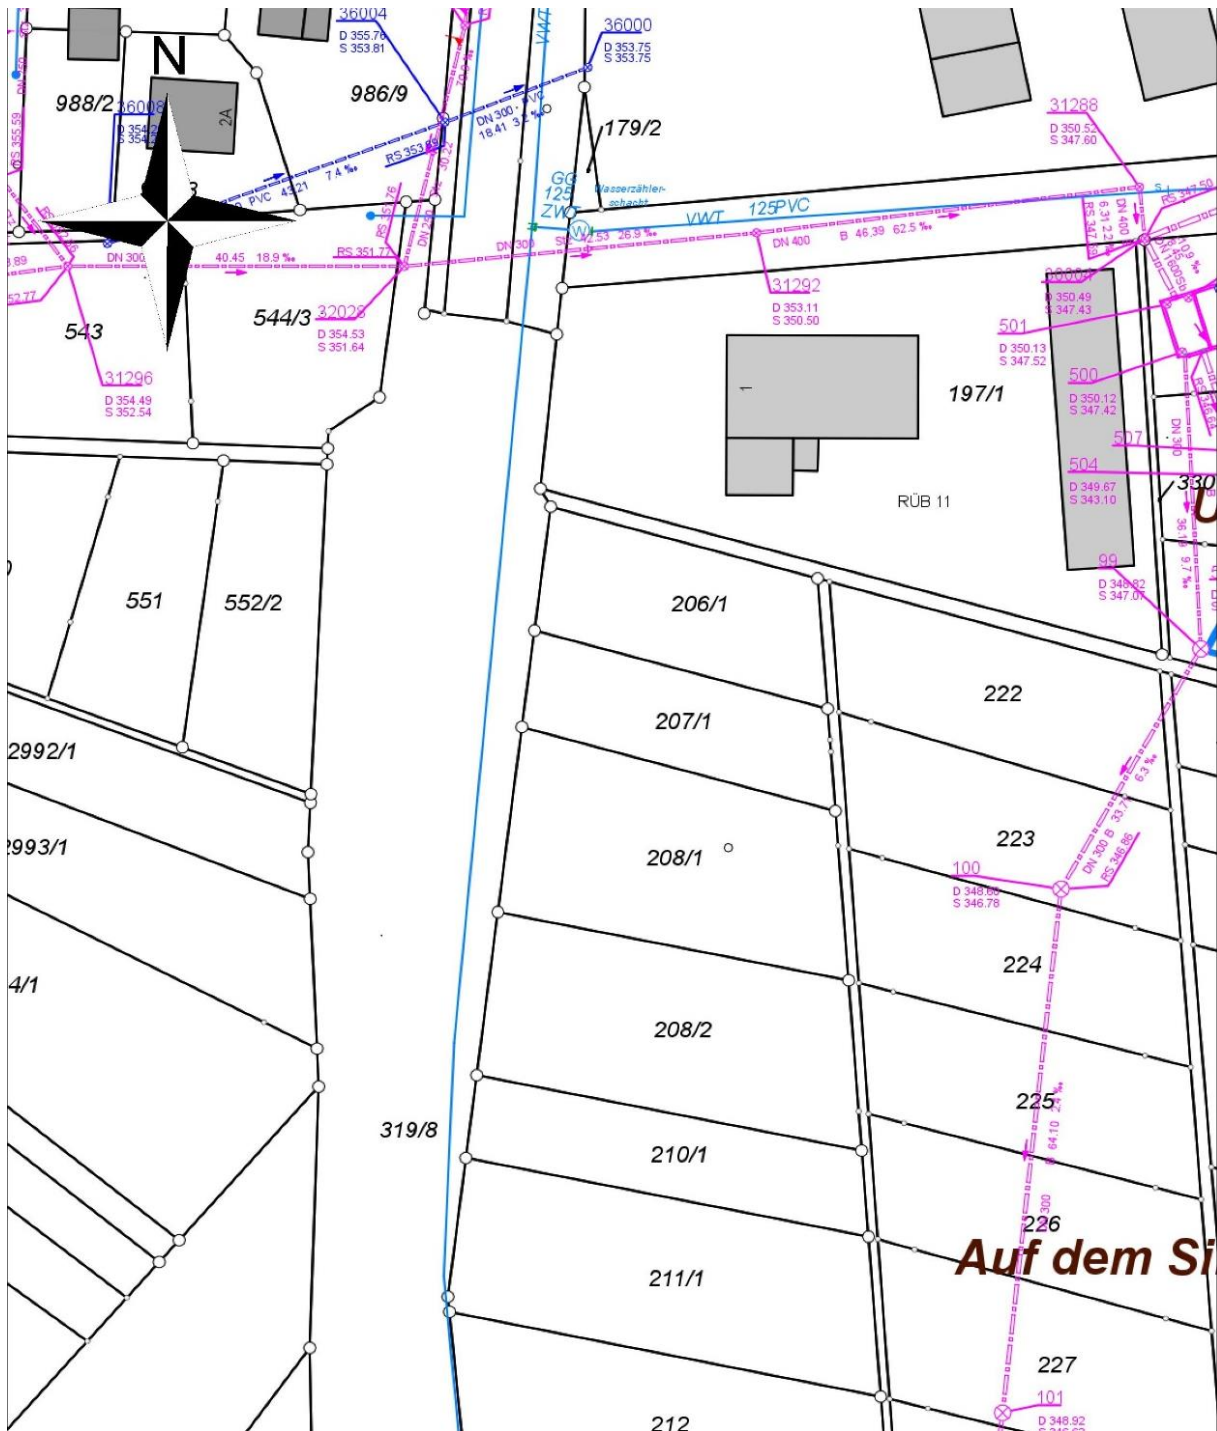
Lageplanauszug „Wasserversorgungsleitung“
